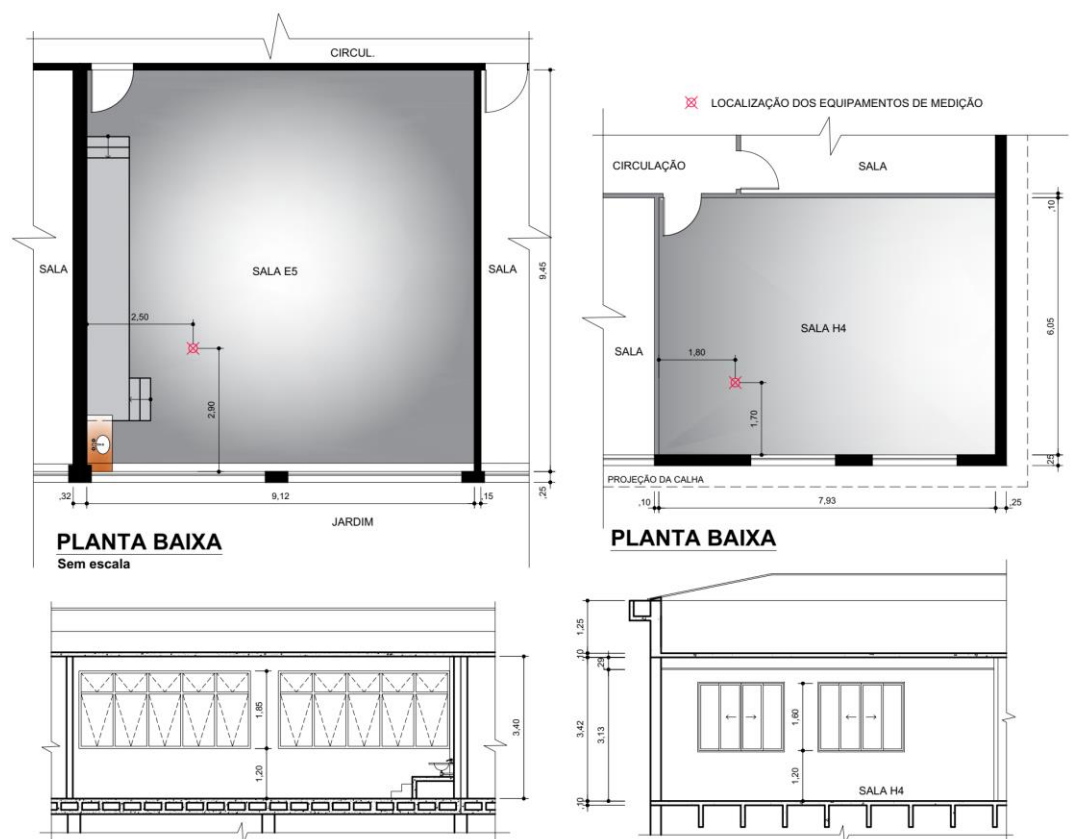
Plantas Baixas com as localizações dos instrumentos de medição e cortes das salas H4 e E5.
